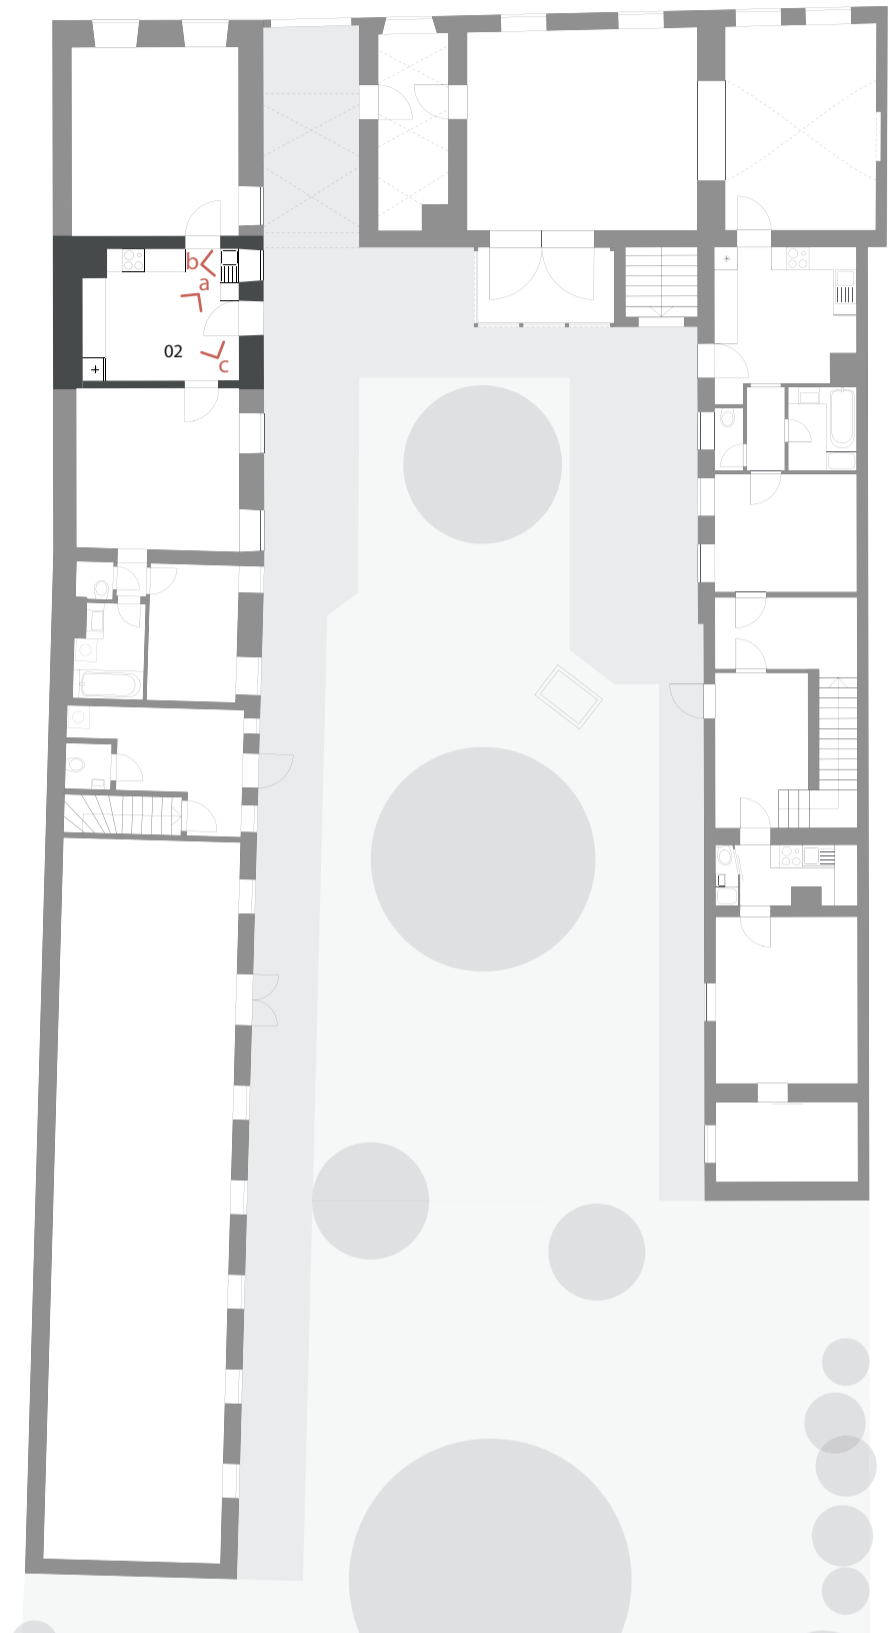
Grundriss Erdgeschoß | M 1:200 | Raum 02
